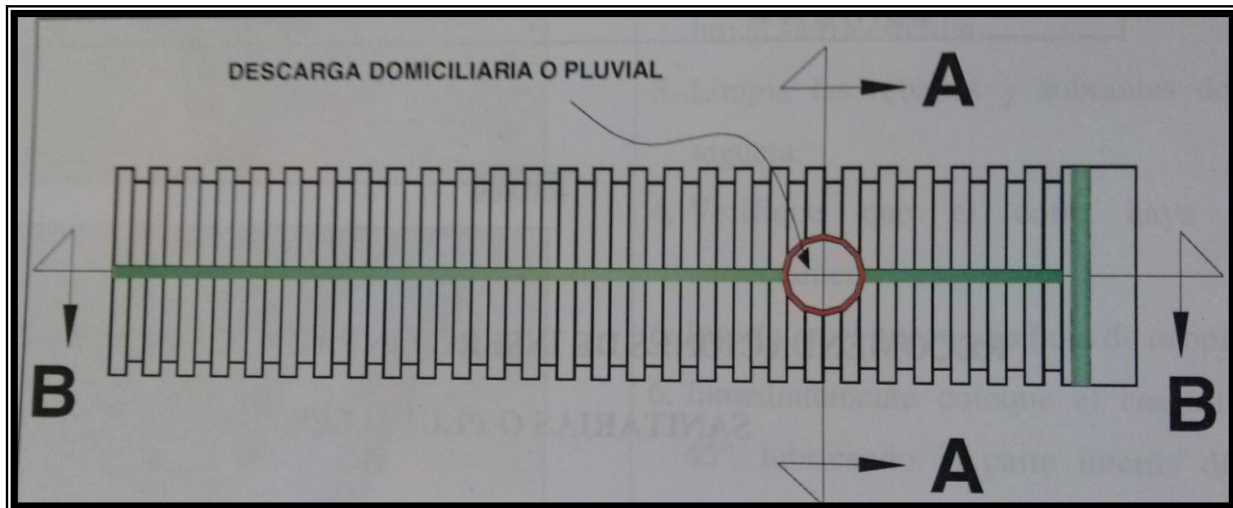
Vista en planta de la tubería de polietileno de alta densidad ADS N-12
